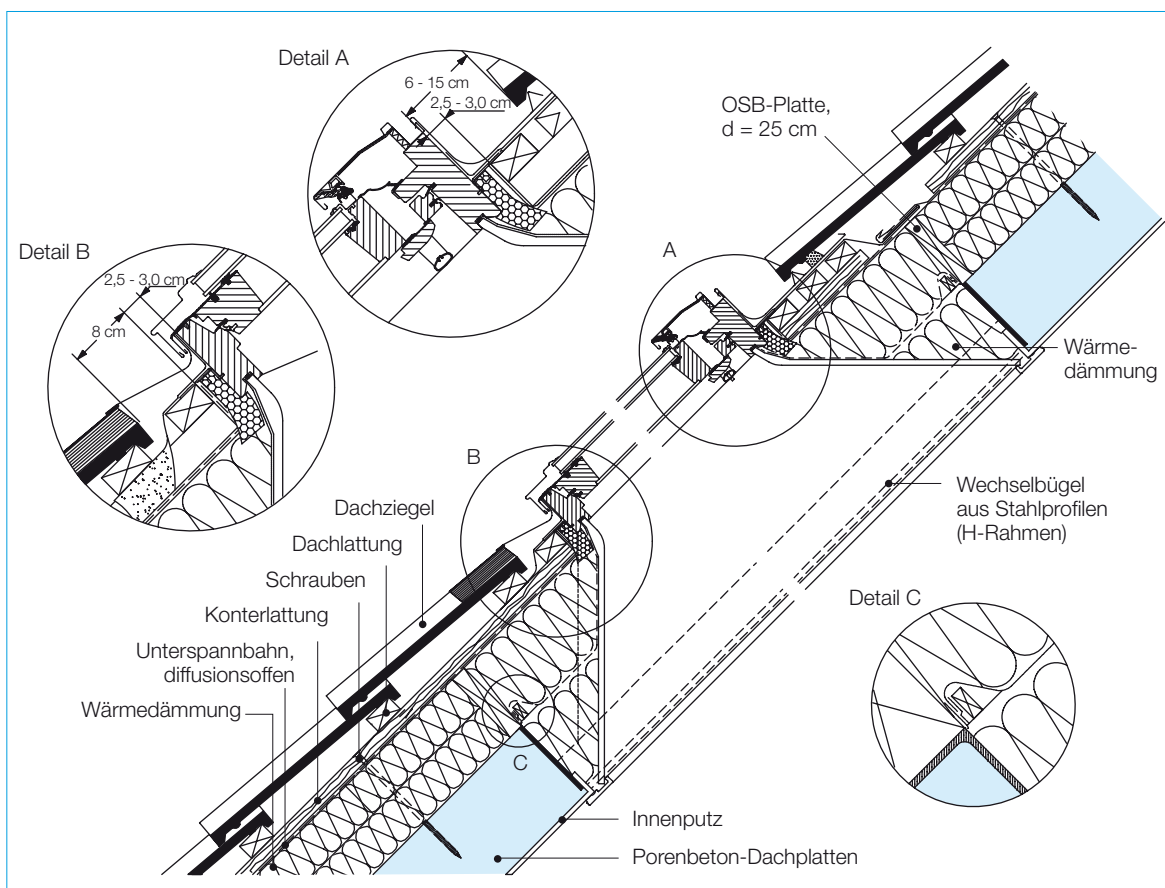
Dachflächenfenster mit Auswechslung in der Dachflächenebene
